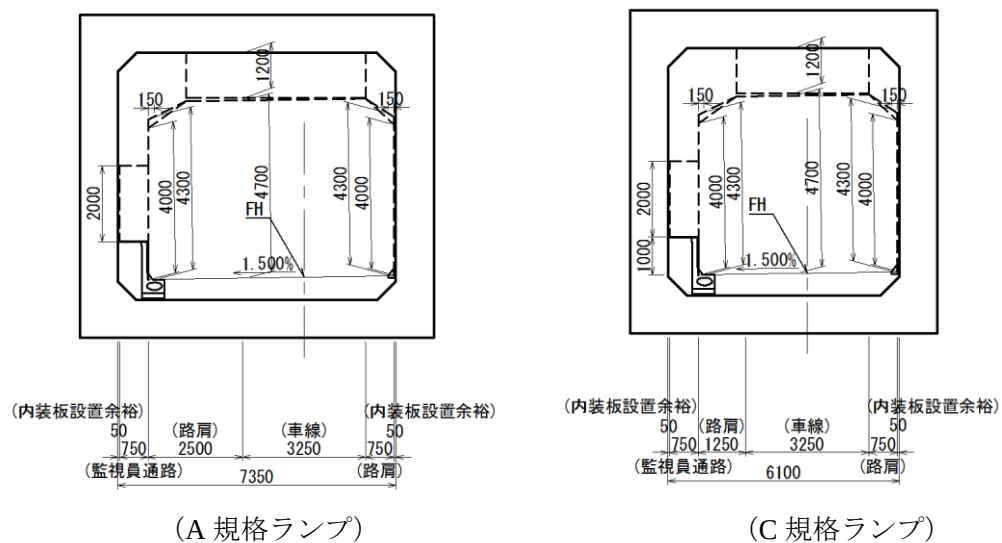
淀川左岸線（2 期） ランプ部 標準断面図
